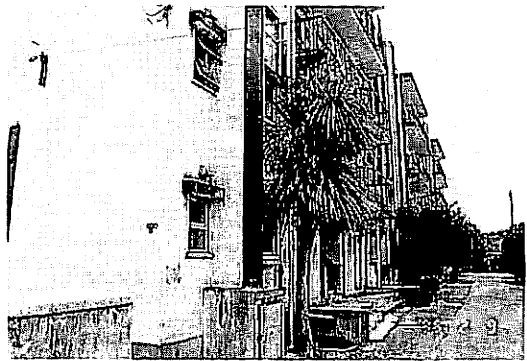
写真-27の健全な壁式RC造4階建て集合住宅
